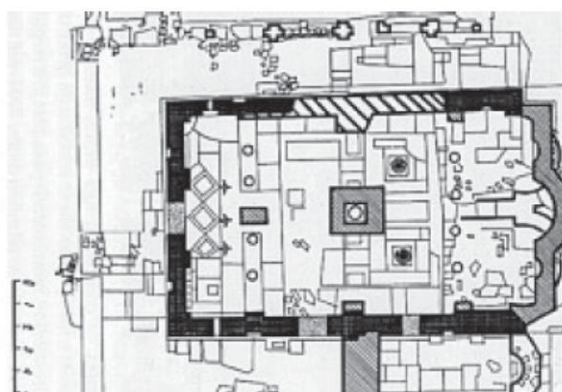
Planimetria della Chiesa con indicazione dei vari periodi di costruzione
